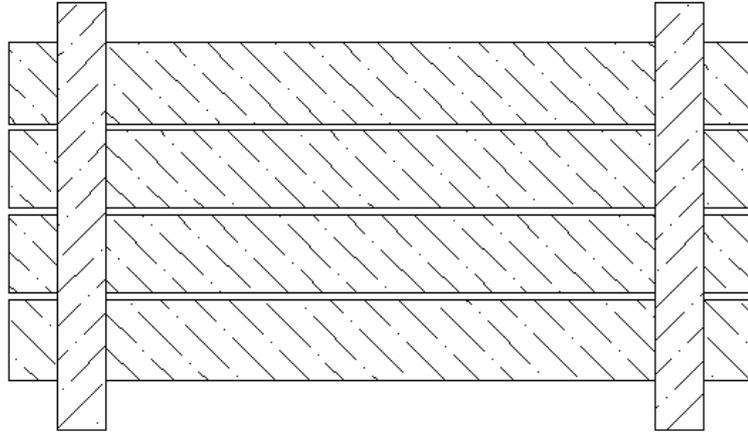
Vista lateral Entibación de madera Cuajada.
